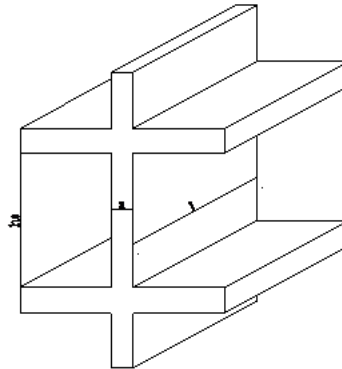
Coupe de voile en élévation (RPA 99 v 2003)
